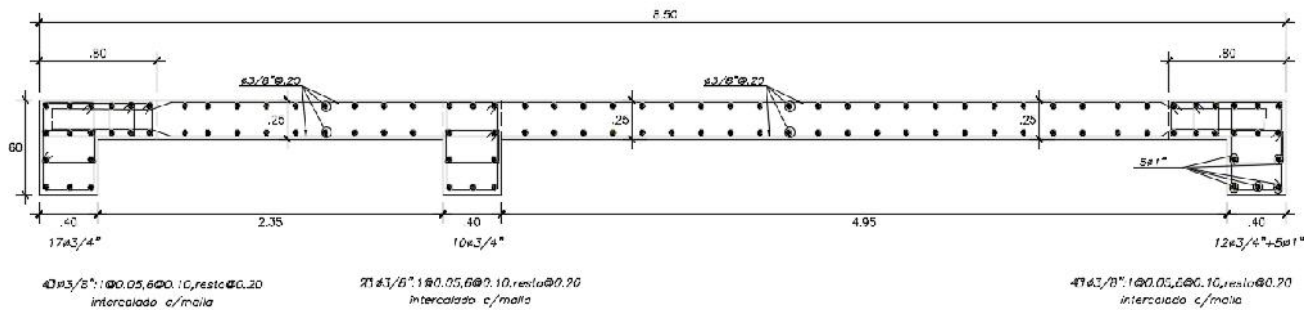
Distribución final refuerzo placa PL-2
